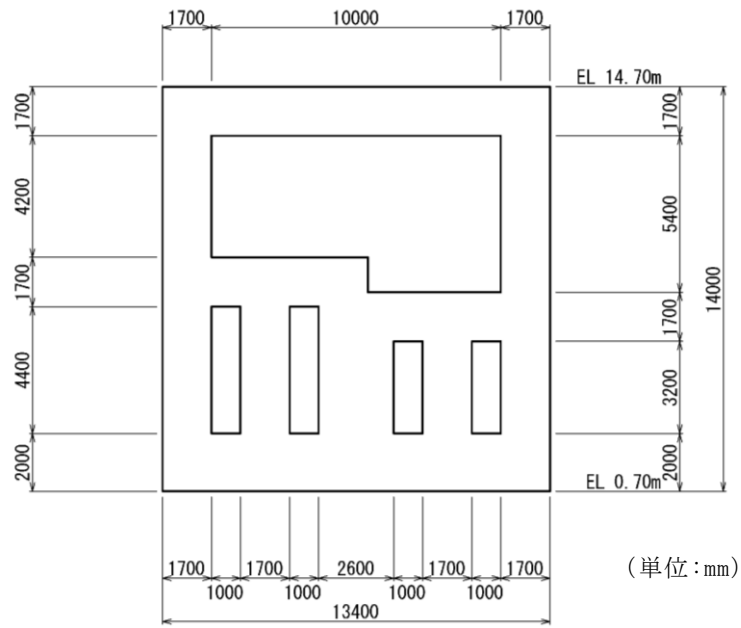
第 1 ベントフィルタ格納槽 断面図 (B-B 断面)
